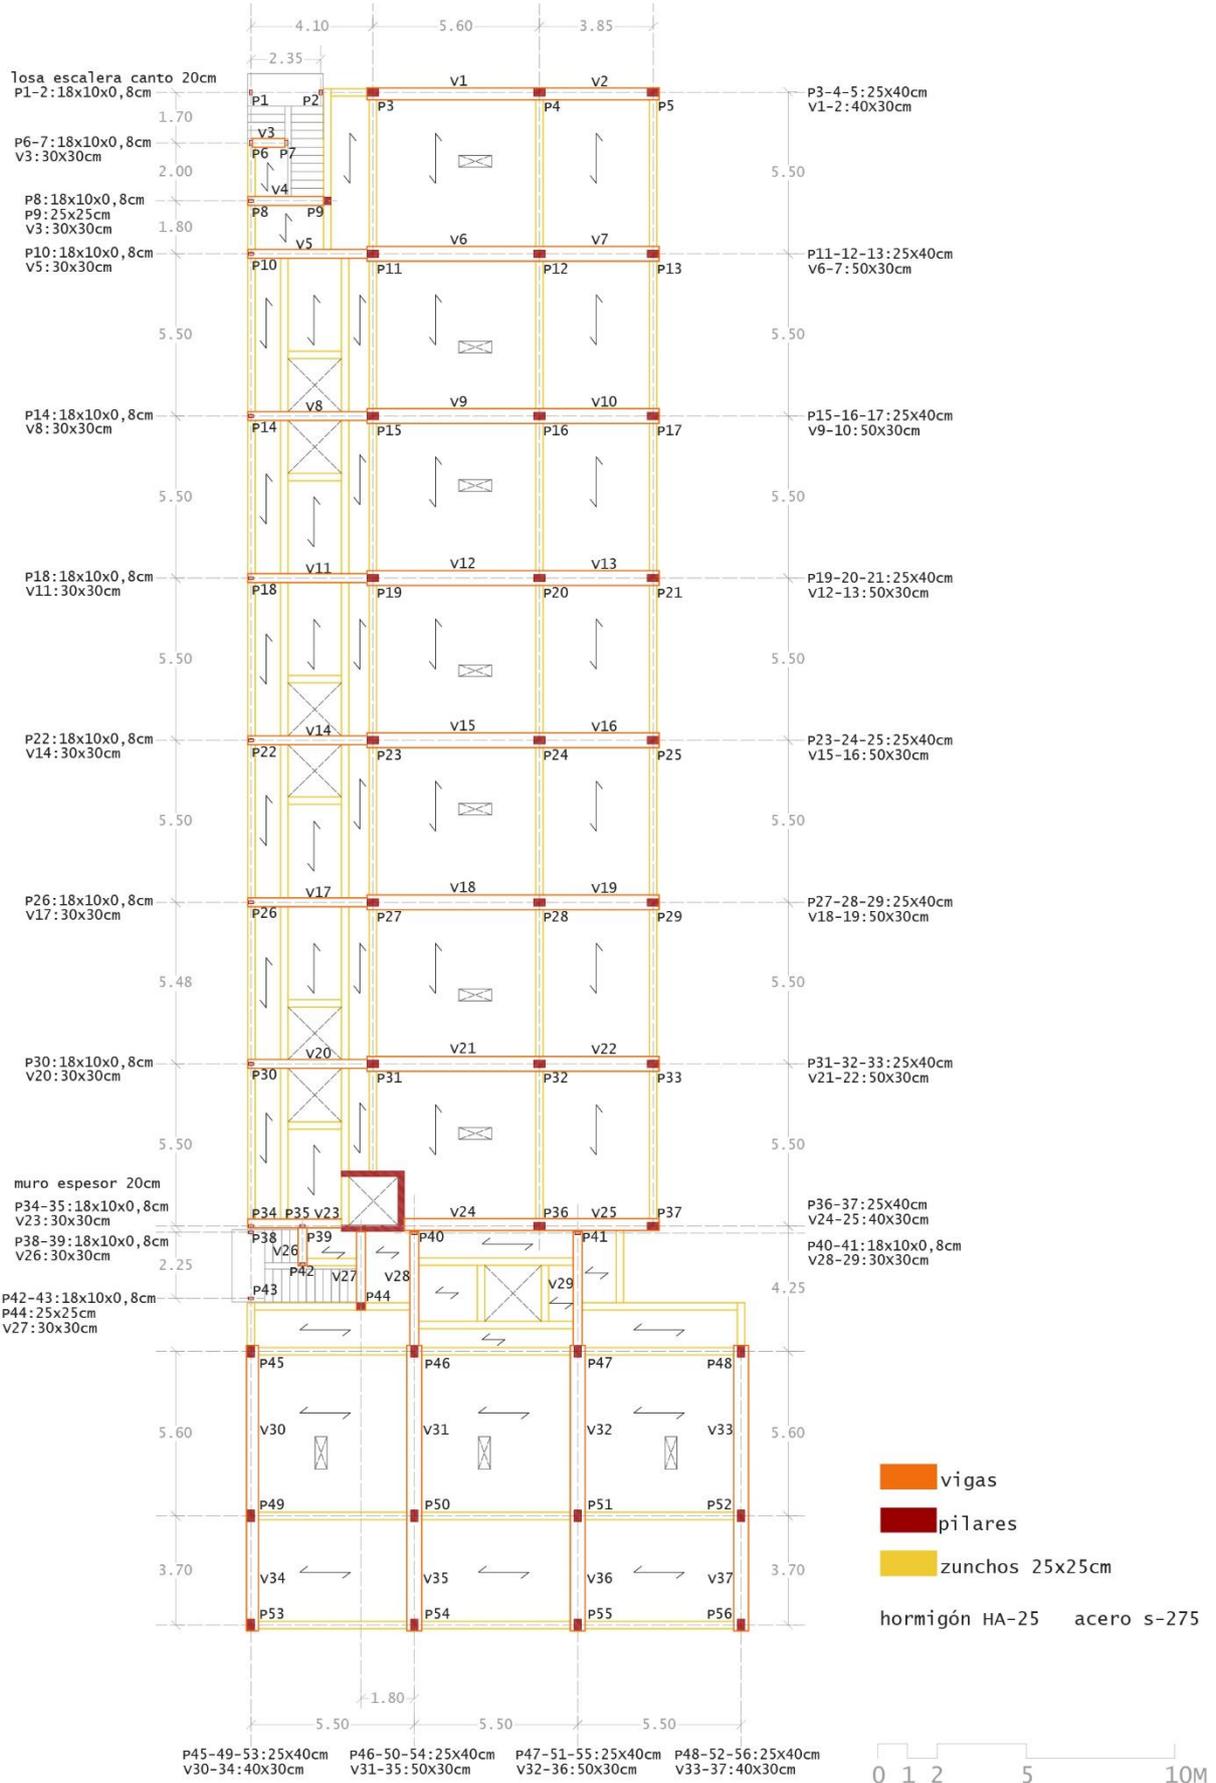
Planta estructural tipo de los forjados 2, 3, 4 y 5 (Modelo 2)
